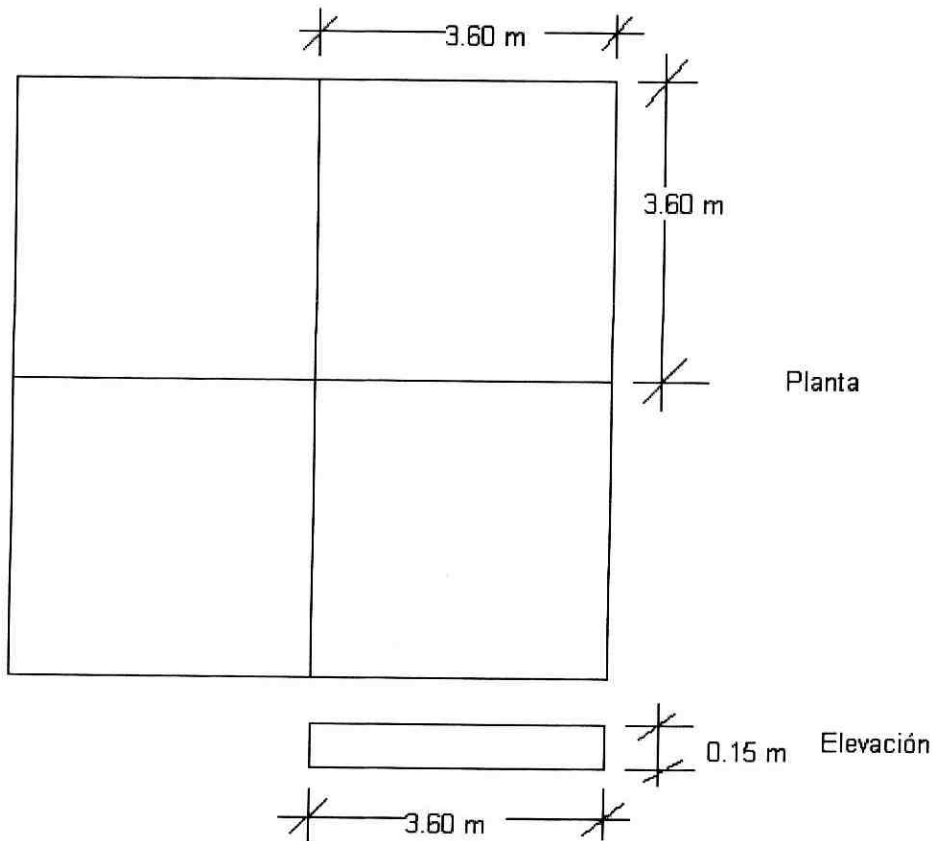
Detalle típico de la losa de cimentación a analizar
